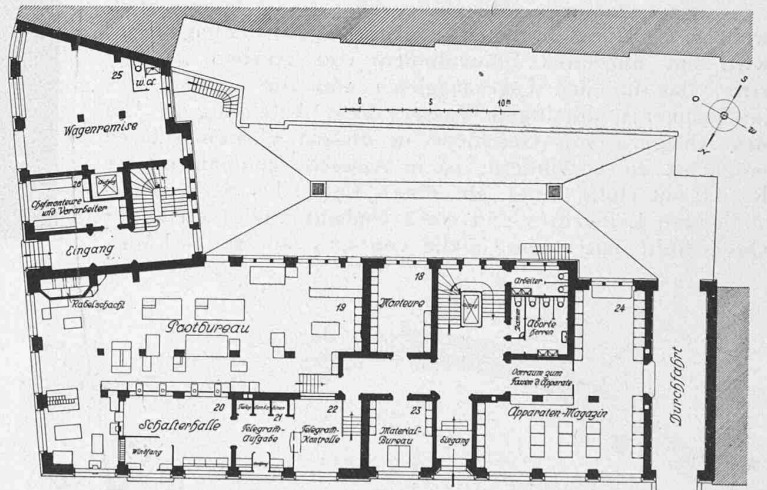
Grundriss vom Erdgeschoss. — 1 : 500.
